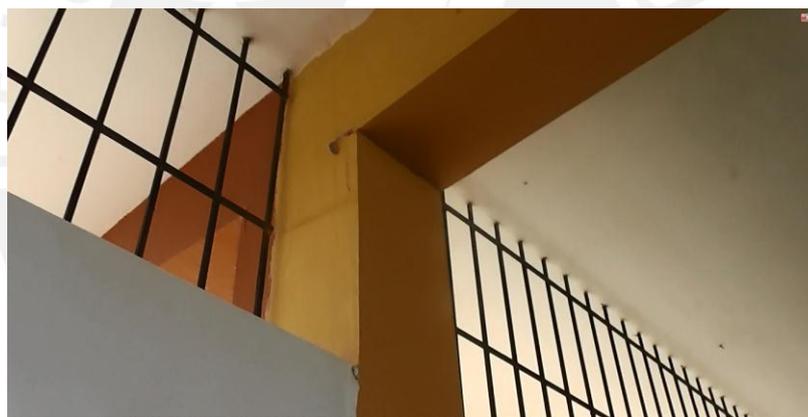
Pequeñas fisuras en las columnas
